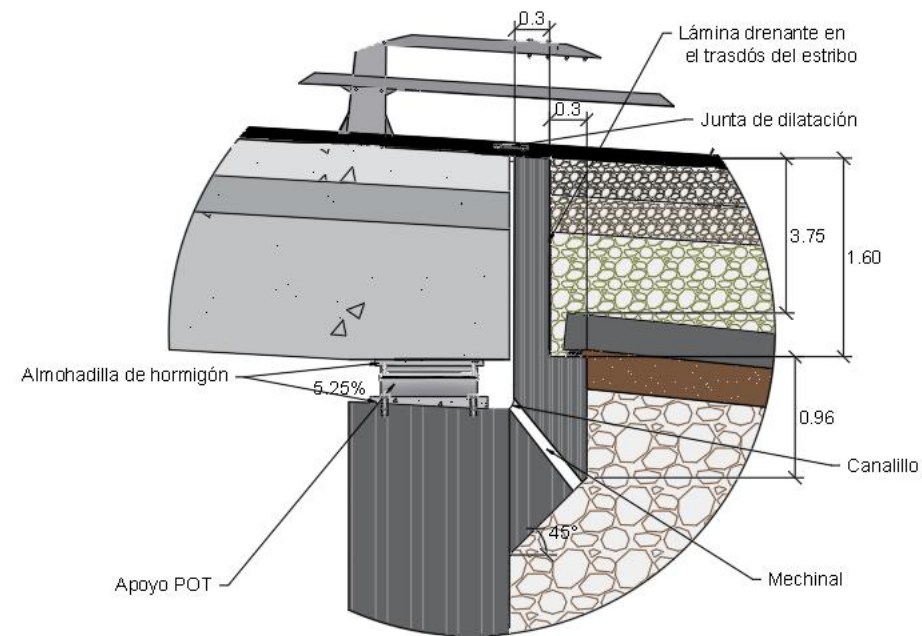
Detalle del apoyo elastomérico en el estribo derecho.
